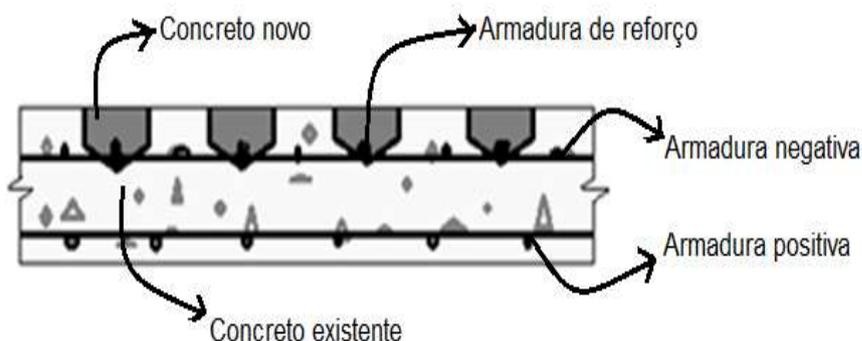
Esquema de reforço por Introdução de novas armaduras em escavação feita na secção existente
